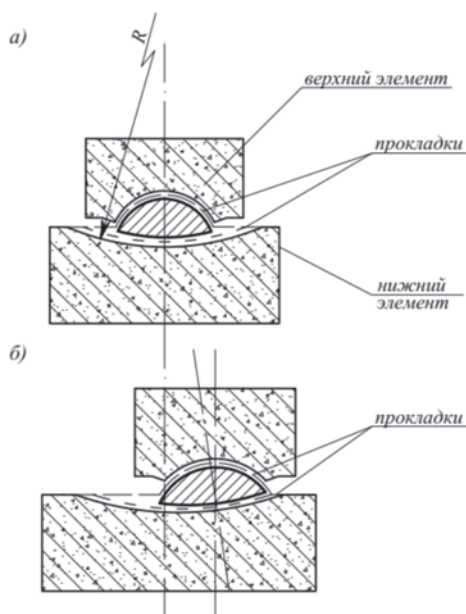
Конструкция скользящей опоры с прокладками из фторопласта-4:
